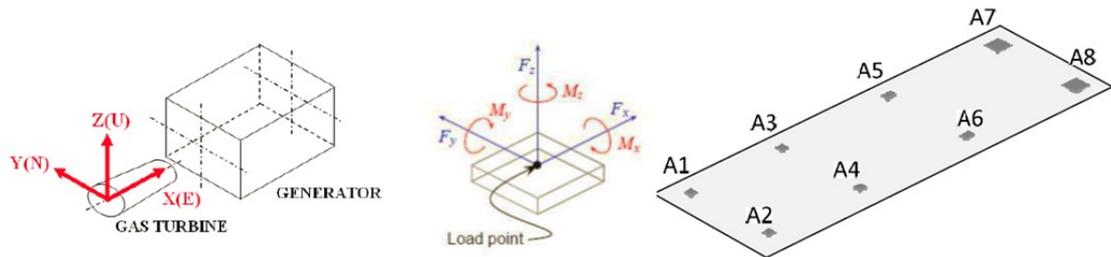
Schema di distribuzione carichi sulle fondazioni
